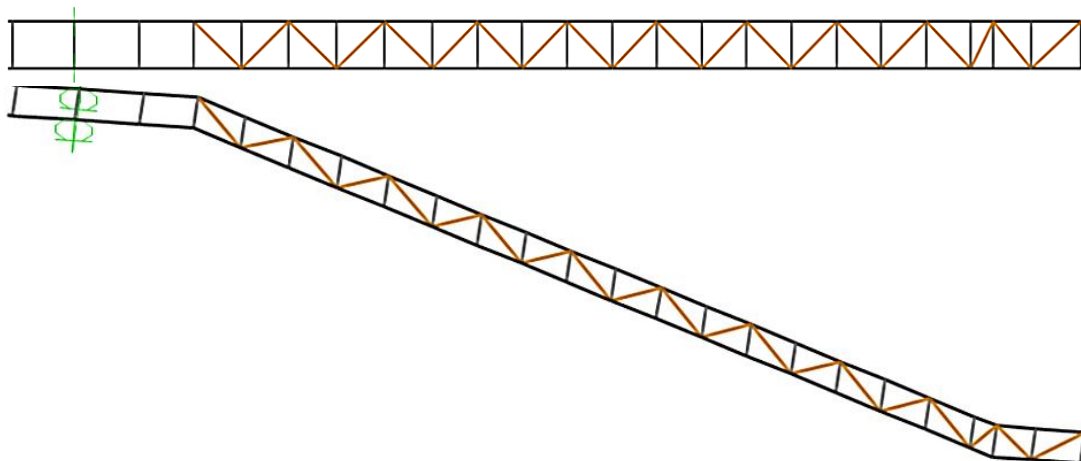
Painel Horizontal Superior - Vista em Planta e Alçado
